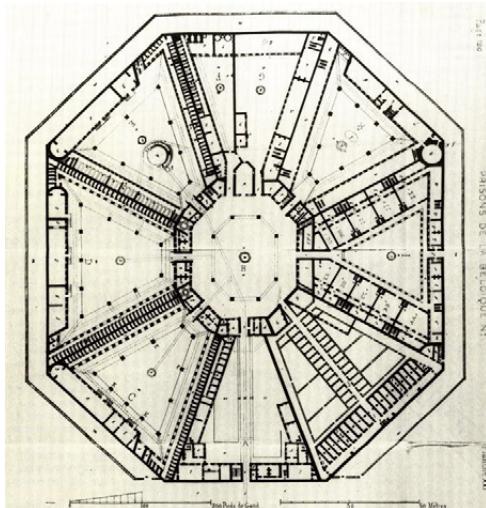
Planta del proyecto de la Maison de Gante (Malfaisón y Kluchman) 1772. PD.
